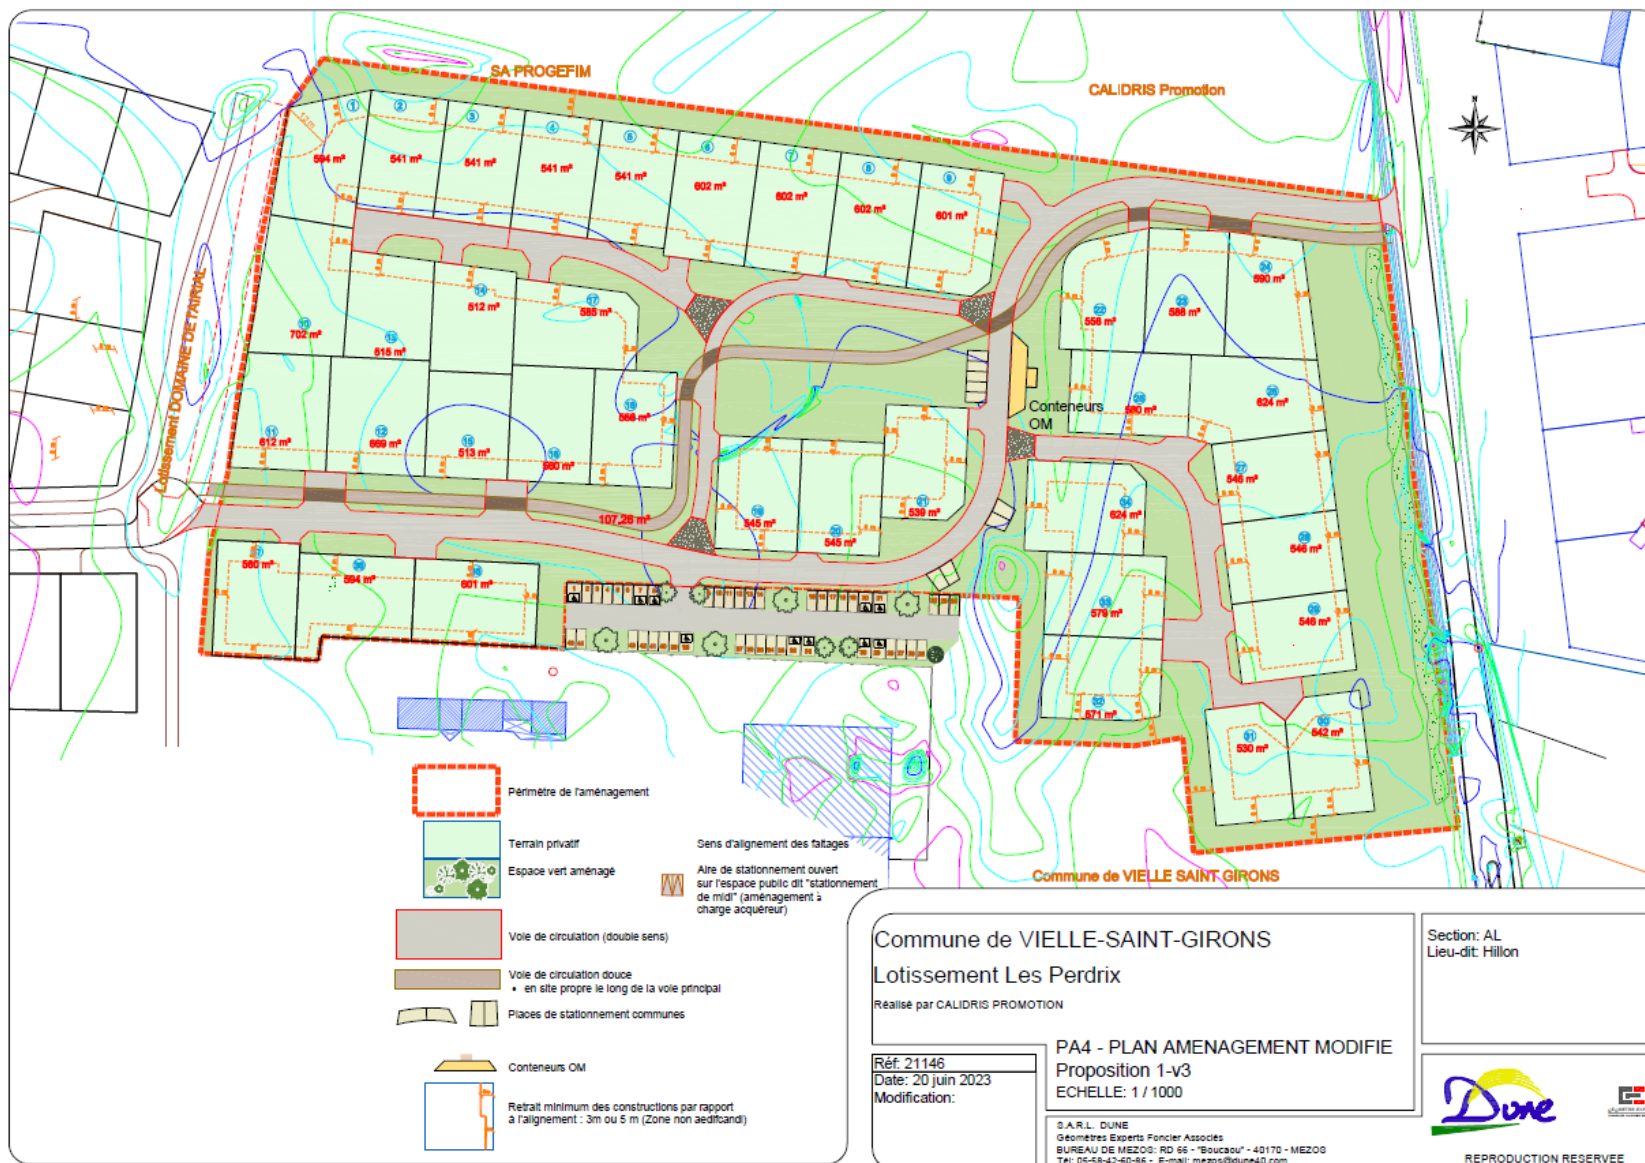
plan de composition modifié (source : SARL DUNE, juillet 2023)
